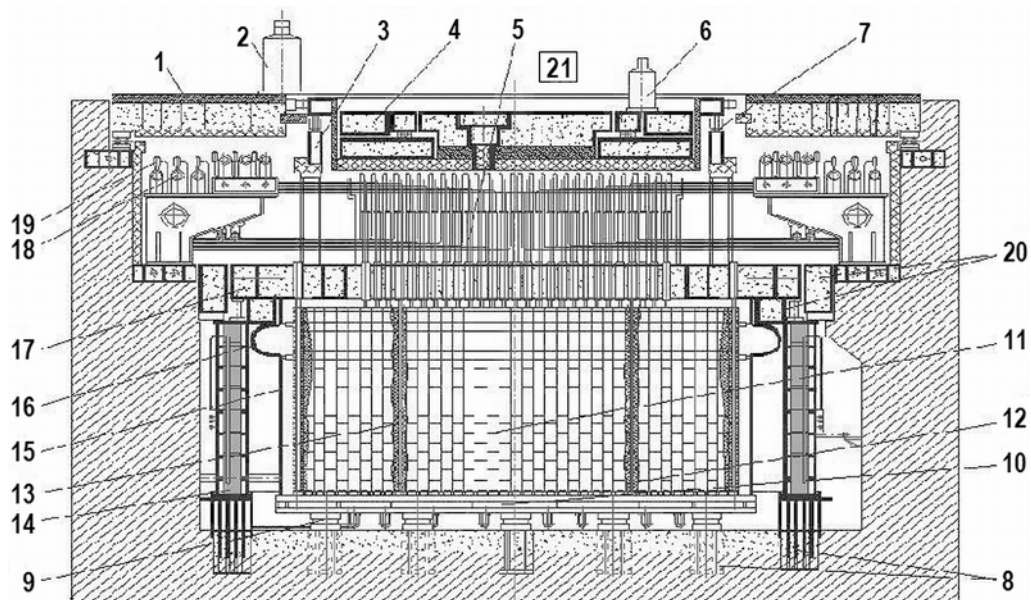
Сечение реактора ЭГП-6 [5]: 1 – верхнее боковое перекрытие; 2 – привод большого вращающегося перекрытия; 3 – центральная рама с опорами; 4 – центральное вращающееся перекрытие; 5 – стойки; 6 – привод малого вращающегося перекрытия; 7 – опора катков; 8 – закладные части; 9 – опорные узлы; 10 – нижняя плита; 11 – графитовая кладка; 12 – канал СУЗ; 13 – ТВС; 14 – бак биологической защиты; 15 – кожух; 16 – компенсатор кожуха; 17 – верхняя плита; 18 – групповые коллекторы с рабочими трубопроводами; 19 – вентили запорные; 20 – нижний слой защитного перекрытия; 21 – центральный зал (ЦЗ)
